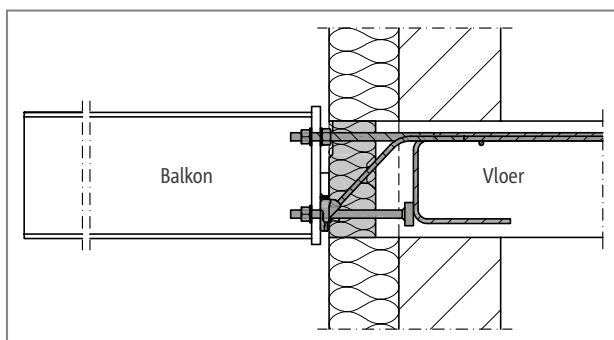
Schöck Isokorf® T type SK: in de spouwmuurisolatie; verbindingsstuk in het werk aangebracht tussen het Isokorf® element en het balkon. Biedt flexibiliteit tijdens het bouwproces (achteraf montage)
